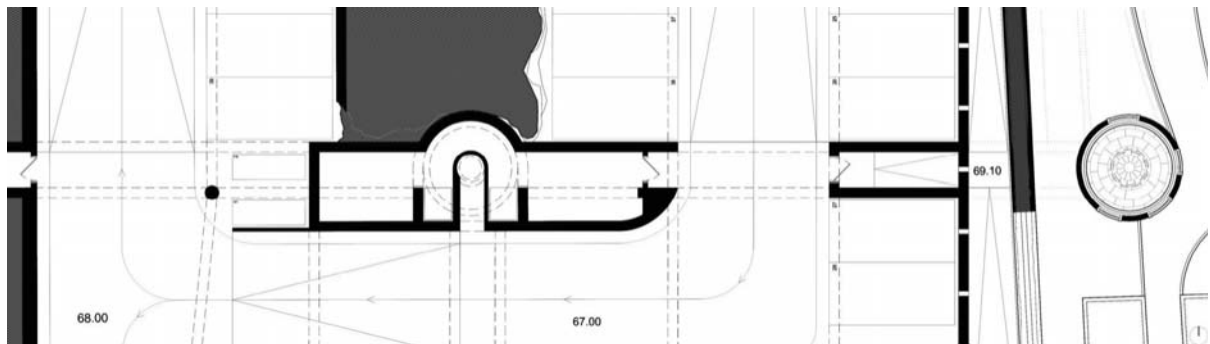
POR. 1 - Planta de estacionamento e túnel: Traçado sobre a suposição.
